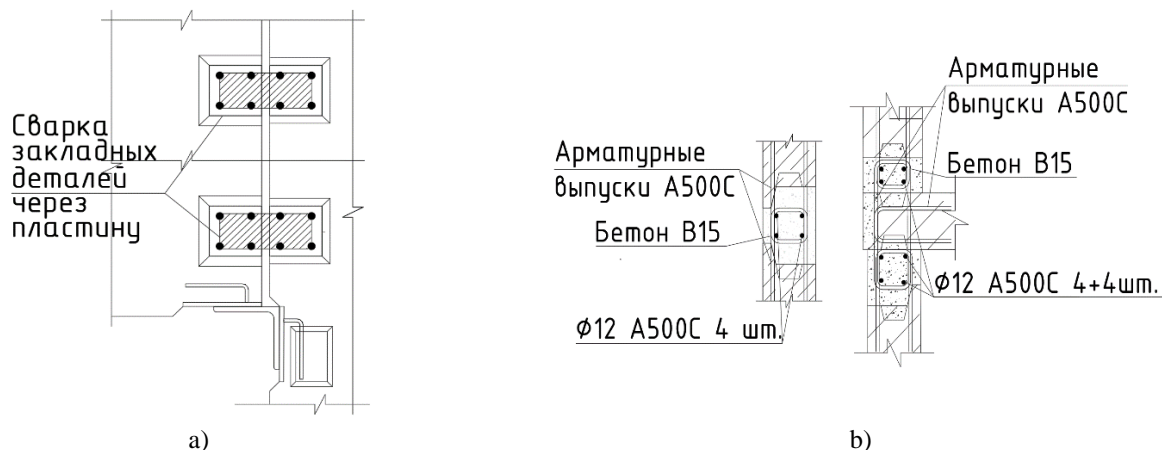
Варианты вертикального соединения панелей между собой: а – жесткое на сварке через пластину; б – упругое на арматурных выпусках (стык двух стен слева и трех стен справа)
